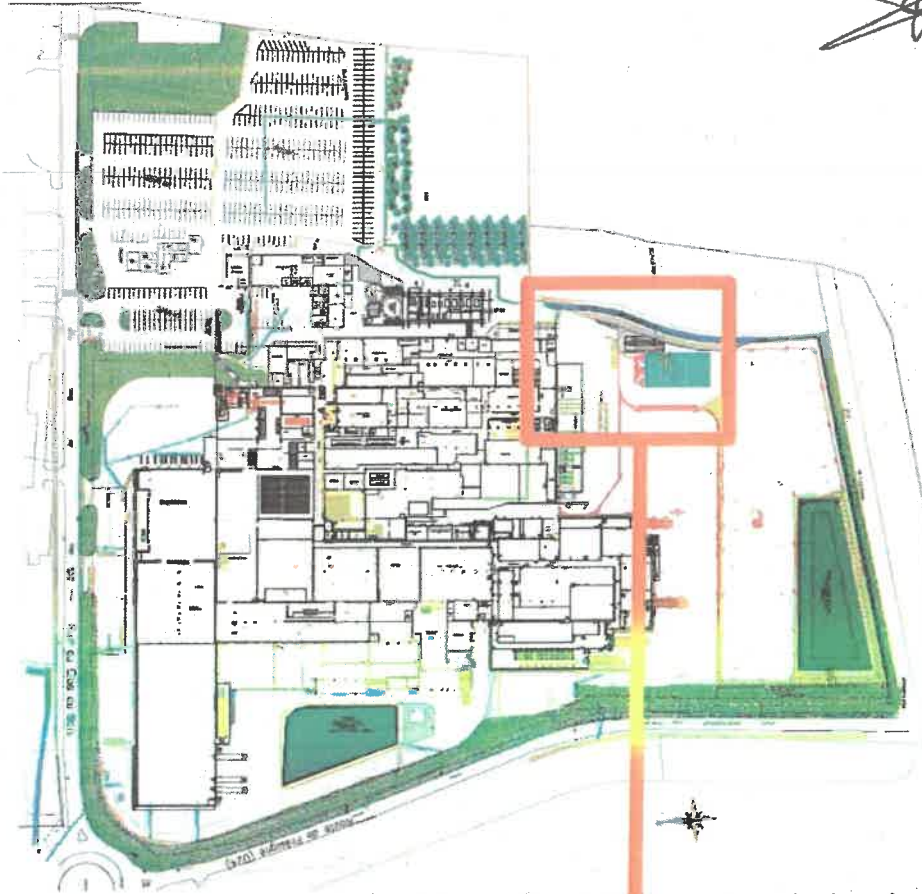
Plan du site LDC DF avec la future implantation de la cuve propane
